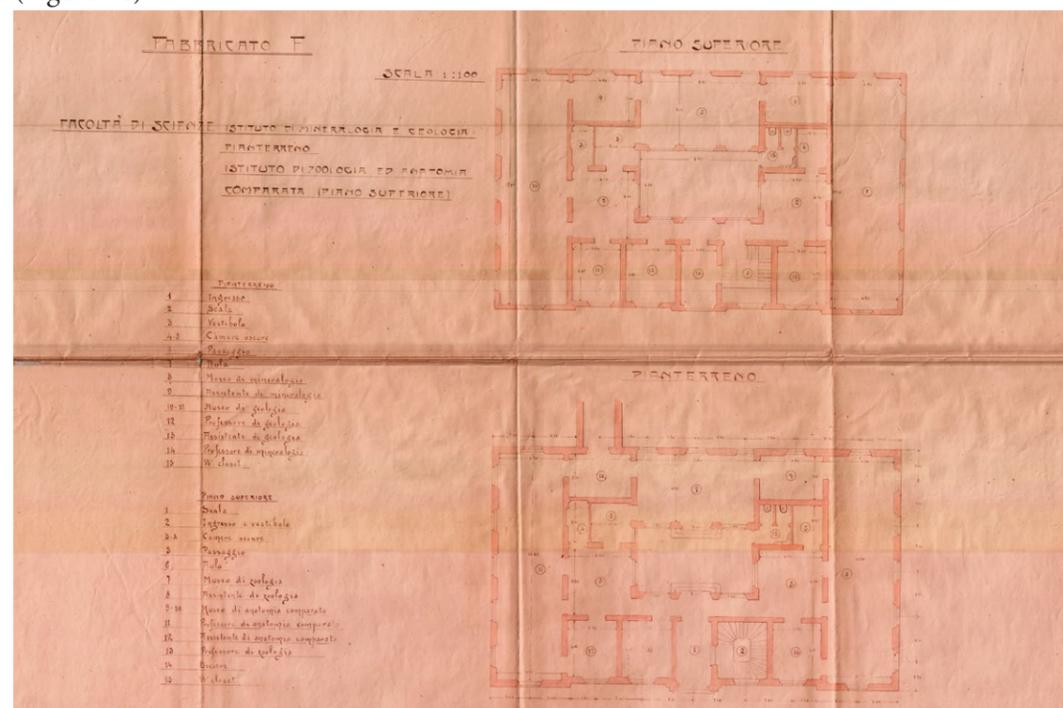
Pianta piano terra e primo piano del fabbricato F secondo il progetto originario (Archivio del Genio Civile di Messina)
